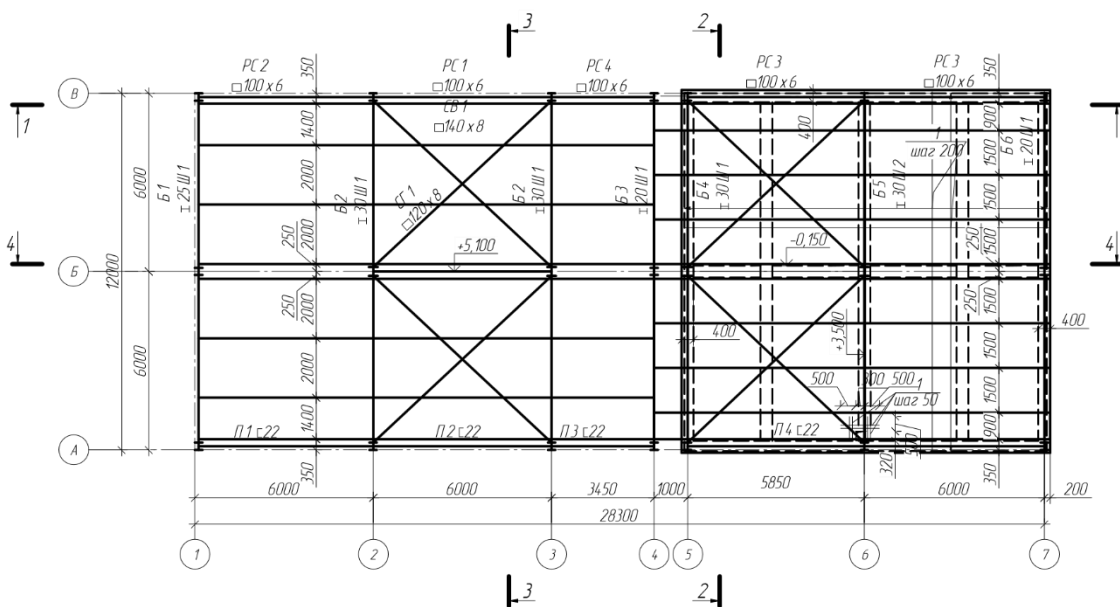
Схема расположения элементов перекрытия и покрытия
